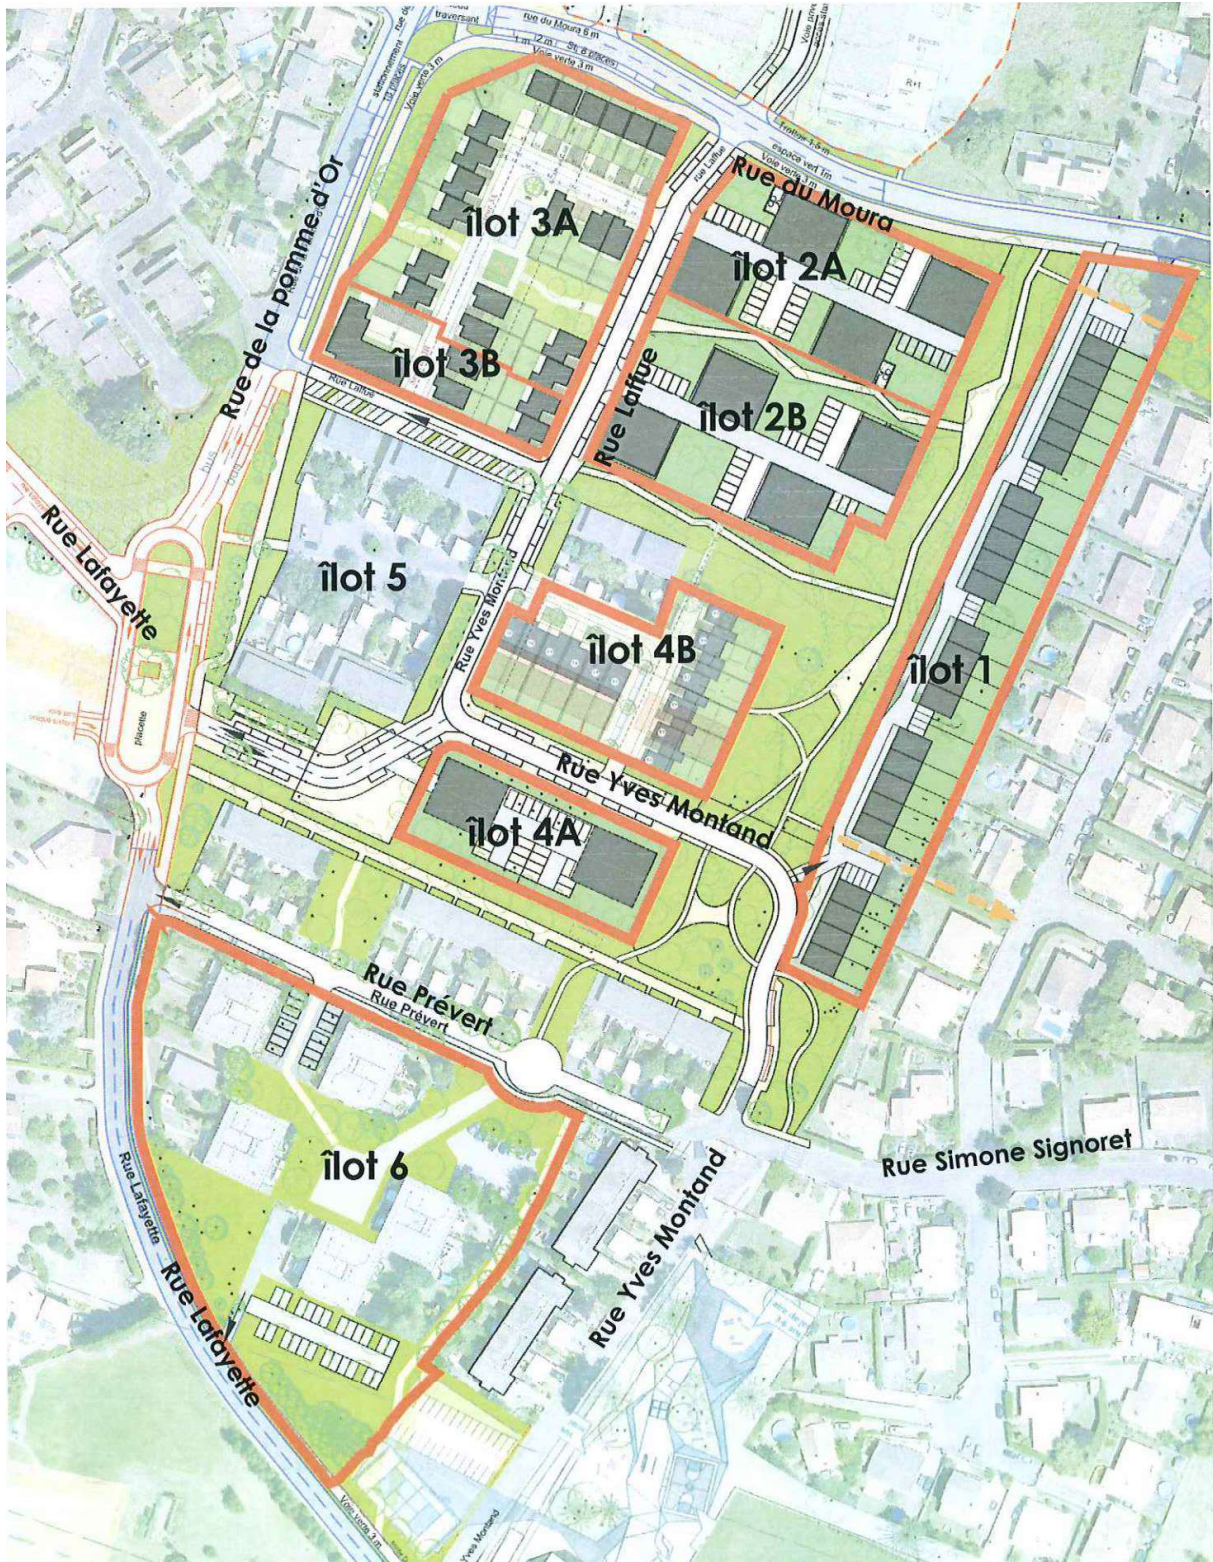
Plan de principe du renouvellement urbain du quartier prioritaire de l'Avenir
